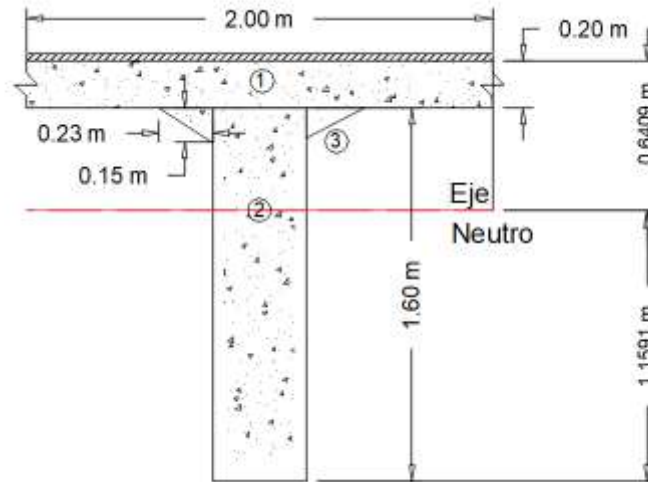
Distancias al eje neutro de la sección transversal de la viga interior.
